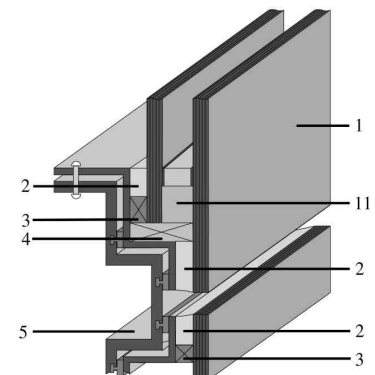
A: Detailzeichnung Kämpfer. Beispiele für Glasfassadenkonstruktionen: zweiseitiges Design (Vor-Ort-Installation).
